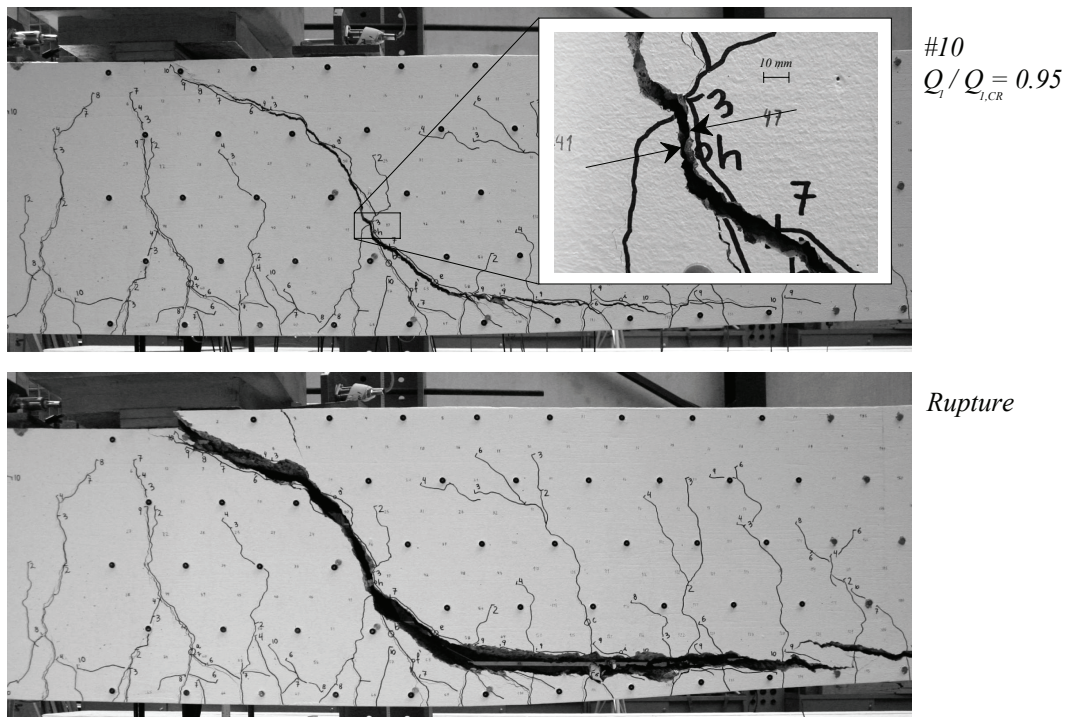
Poutre SR3: Fissuration avant rupture en travée (palier 10) et après rupture
